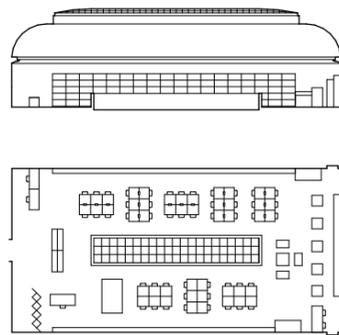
Grundriss und Schnitt des Lesesaals im MAK, M 1:500
